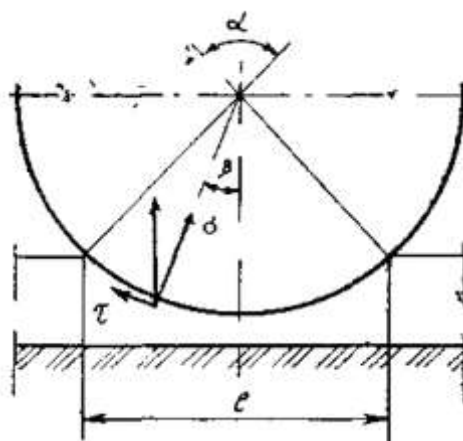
Схема к расчету напряжений в изоляционном покрытии опорной части трубопровода
